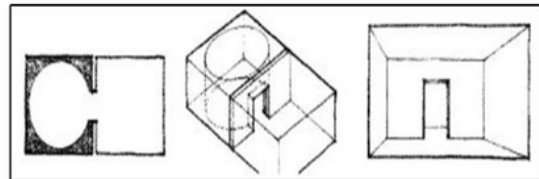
Ruang yang saling berkaitan menghasilkan sebuah ruang
